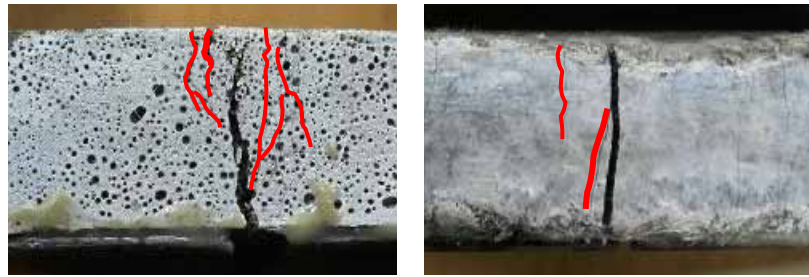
模擬ひび割れ幅のみが異なる試験体のひび割れの様子
